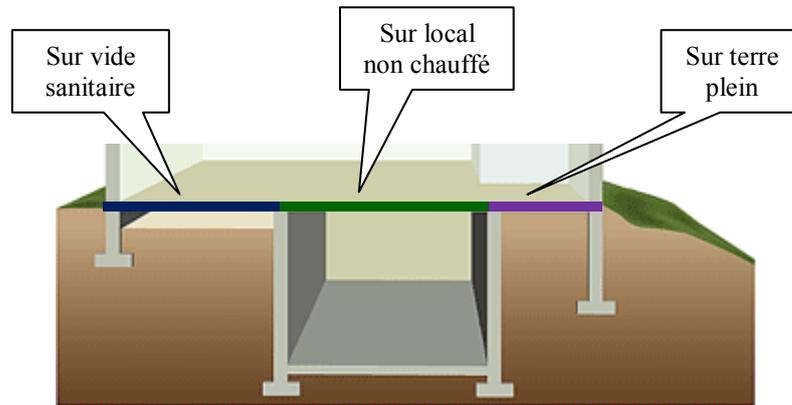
Trois configurations des planchers bas. (Source : auteur)
